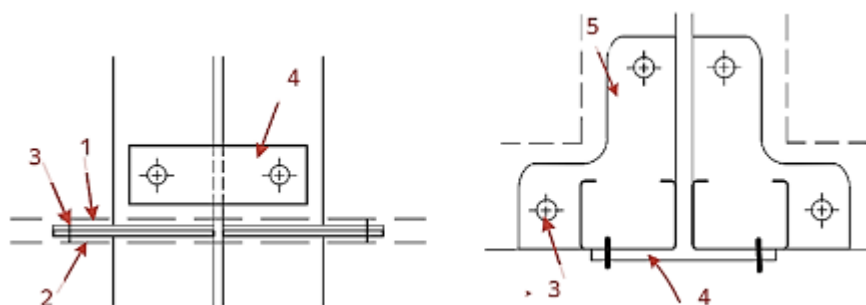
Схема деталей крепления модульных блоков: 1 – пол, 2 – потолок, 3 – болтовое крепление, 4 – стяжка, 5 – опорная пластина [5]
